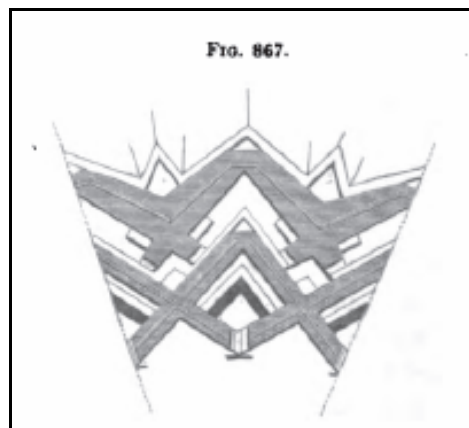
Escola Alemã – D'Harsch. Planta de Fortificação. Ibidem, pág..506.
